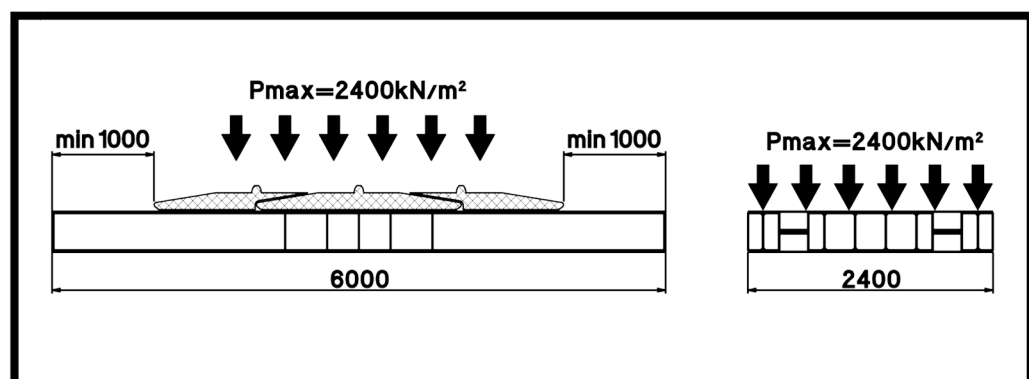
Transitar con la grúa sobre orugas en sentido transversal por la plancha de apoyo
